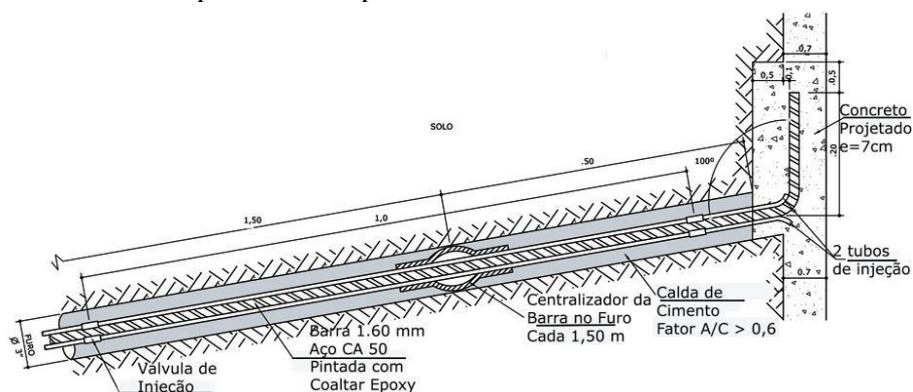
Detalhe da dobra dos grampos sub horizontais e corte do paramento de concreto projetado
